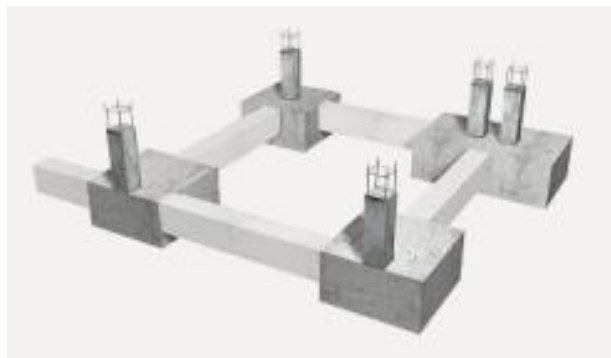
Vigas de fundação (Lustosa, 2018)
